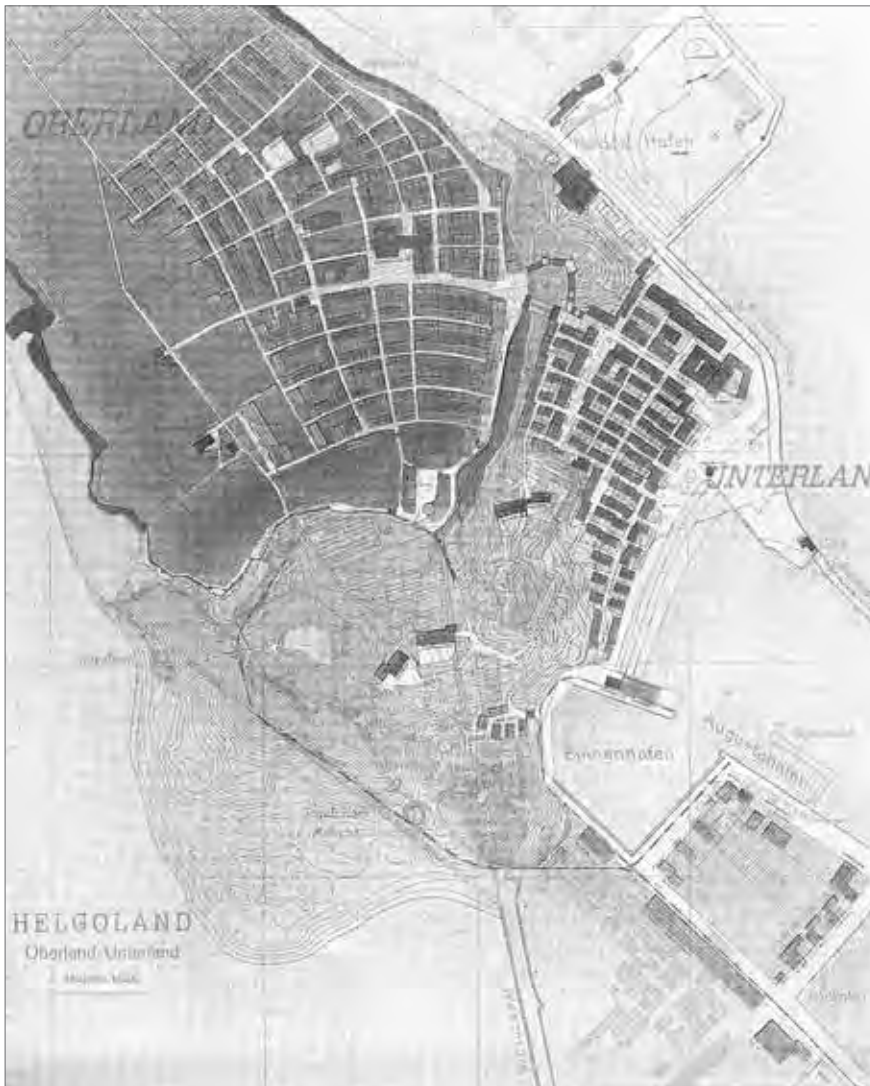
Lageplan Unterland, 1952 Wettbewerbsbeitrag Wellhausen/Bunje (Höhns: 1990)
